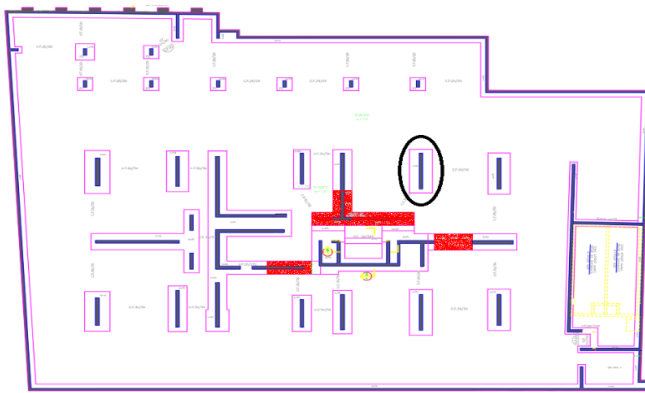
Plano Planta de fundaciones, edificio habitacional de 10 niveles.
